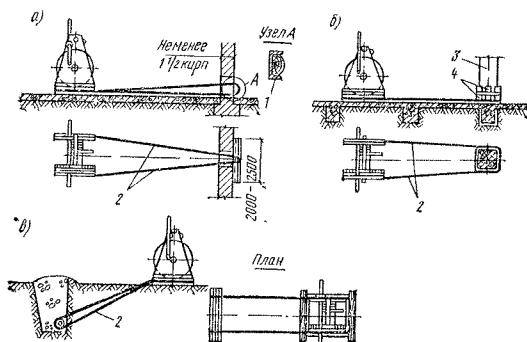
Крепление барабанных лебедок к строительным конструкциям: а — за кирпичную стену; б — за колонну здания; в — за якорь; 1 — швеллер № 10; 2 — стальной канат; 3 — колонна; 4 — планки
